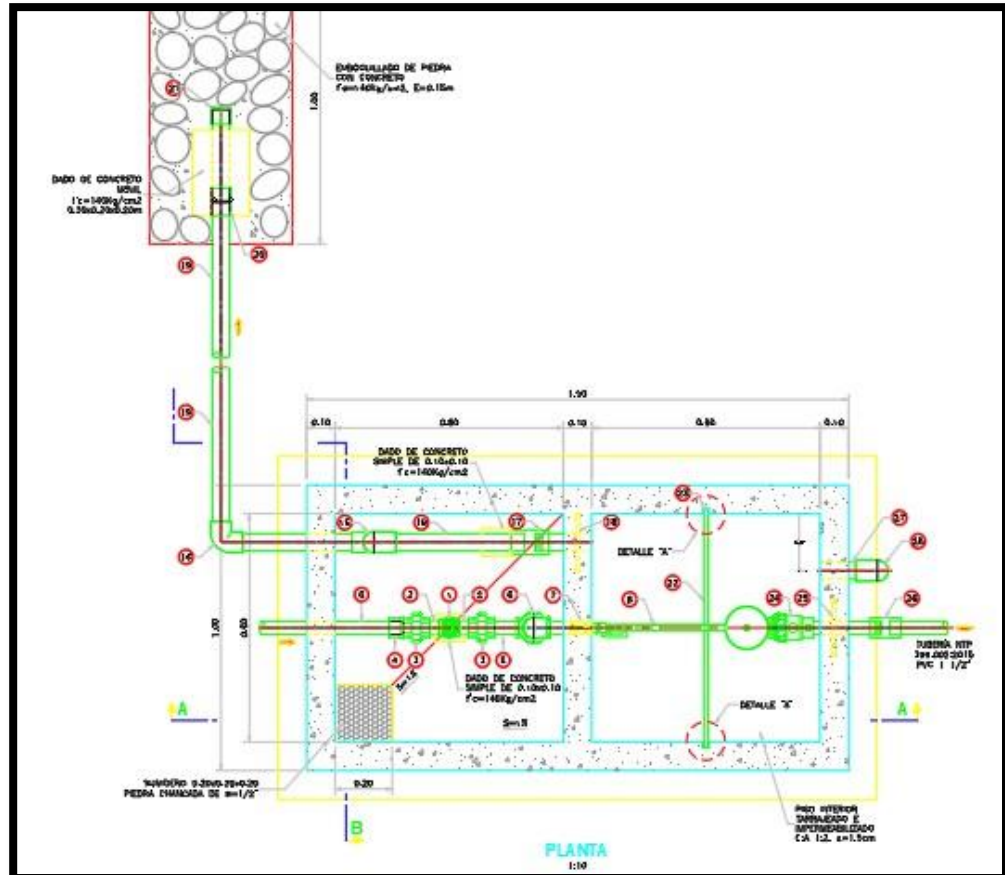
Planta de cámara rompe presión tipo 7
